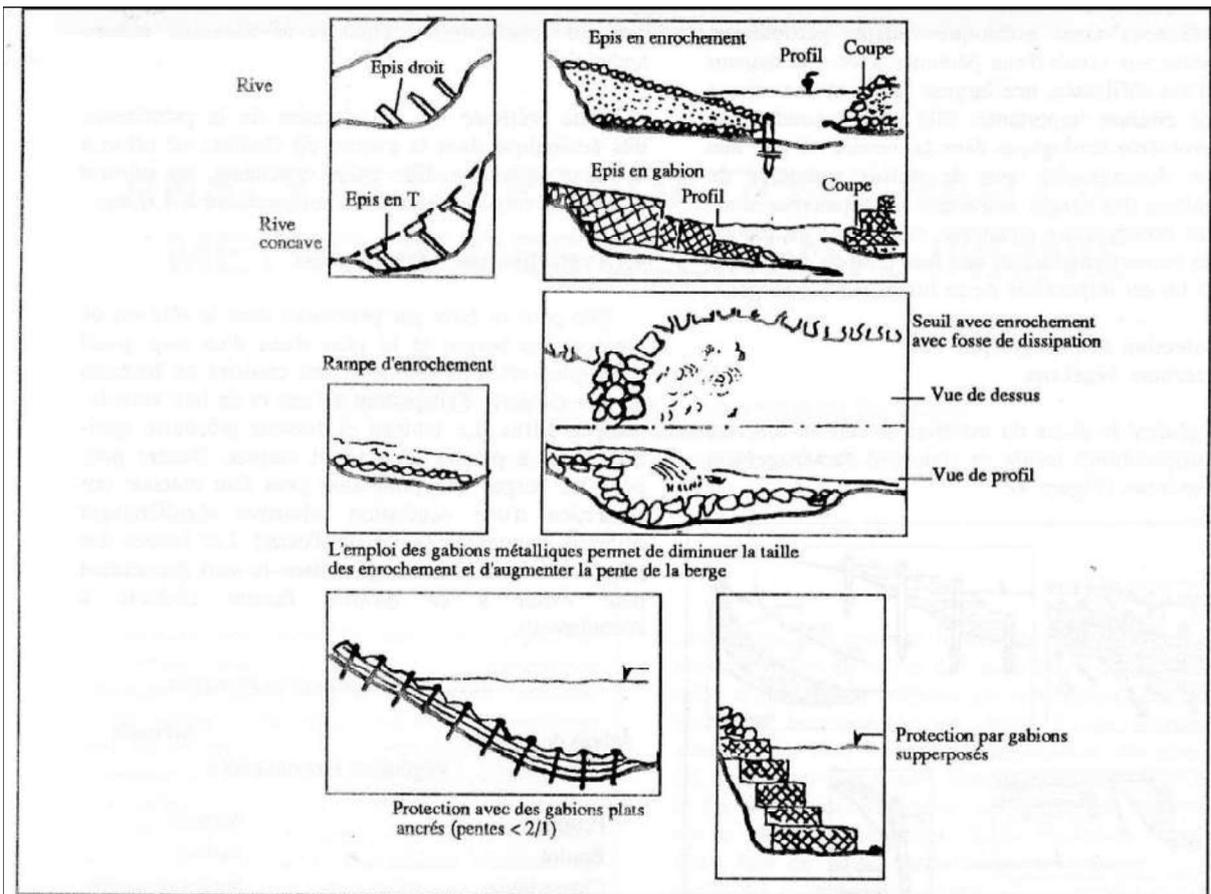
Protection des berges et du lit par des matériaux minéraux.
